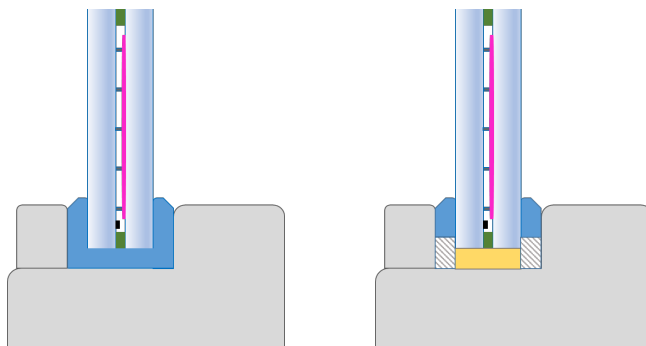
Installation plein bain et utilisation de mousse de fond de joint
